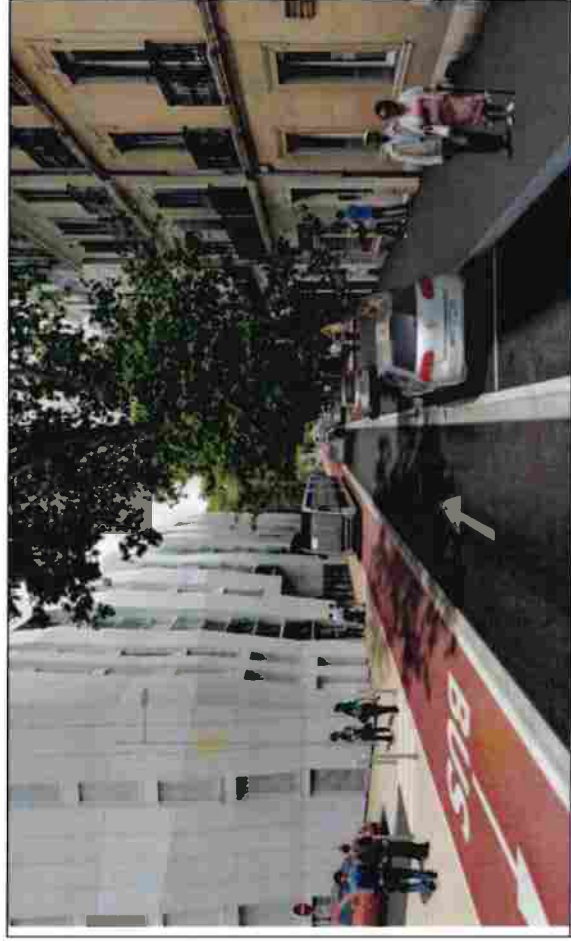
SOLUTION 1 - BHNS EN SITE PROPRE VERS TOULON SECTEUR SAINT-JEAN-DU-VAR
